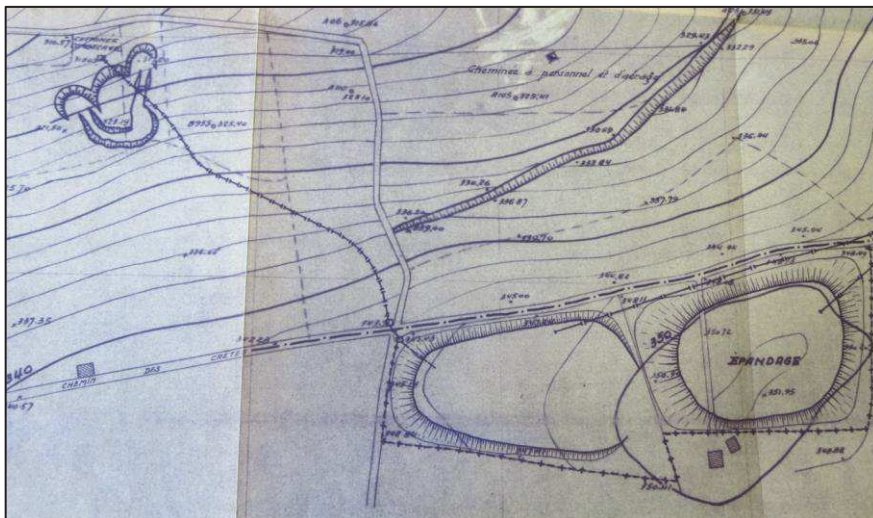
Plan de la « digue » n°1 et de la conduite d'évacuation des eaux de décantation vers les travaux miniers de Combecave daté de juin 1963 [PLA-AD-45]
